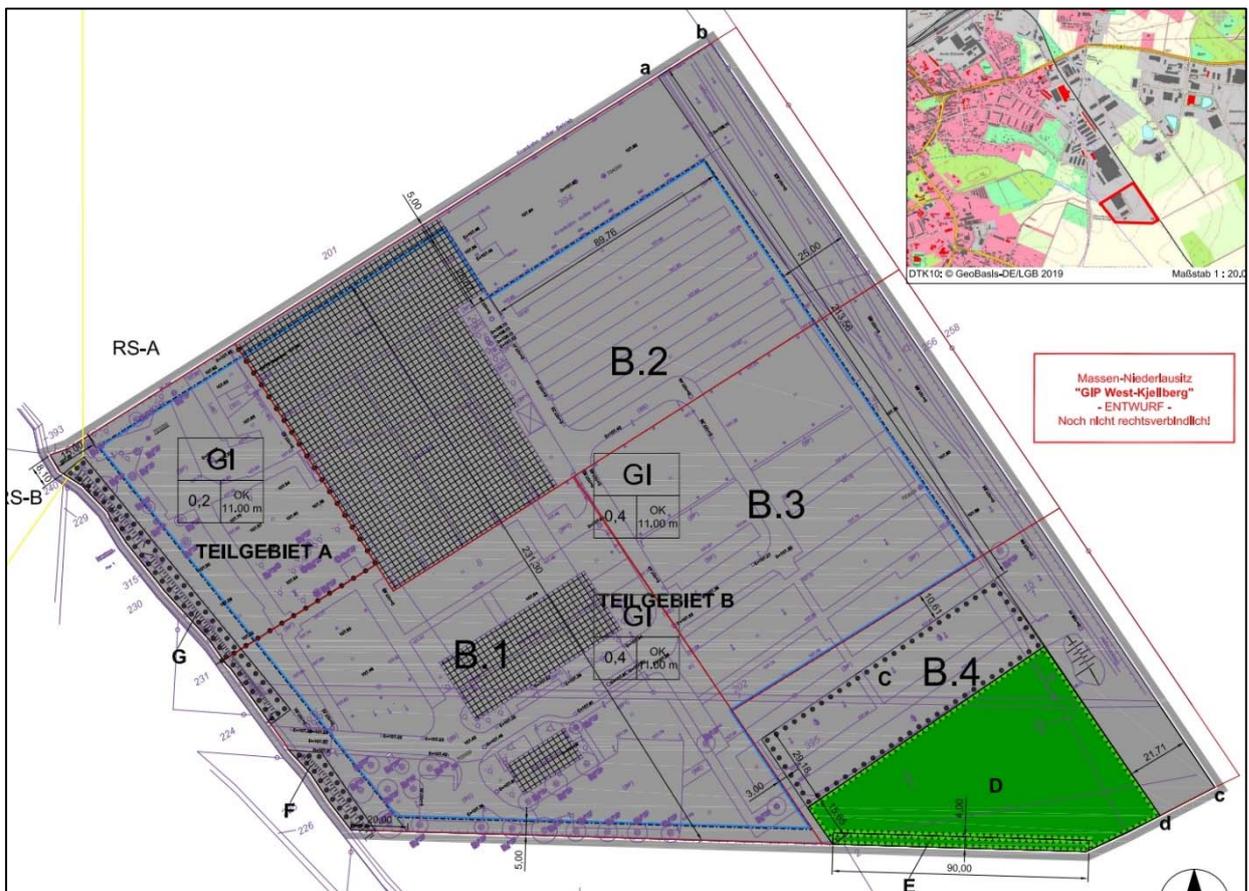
Ausschnitt Planzeichnung zum B-Plan (Entwurf, Stand 29.06.2021, PLAN UND RECHT GMBH)
